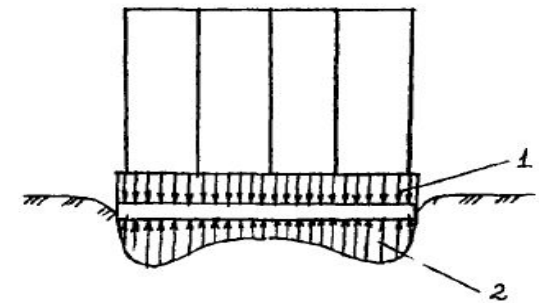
Распределение напряжений под фундаментами абсолютно жестких сооружений 1 – распределенное равномерное давление по обрезу фундамента. 2 – эпюра контактных напряжений под подошвой фундамента
